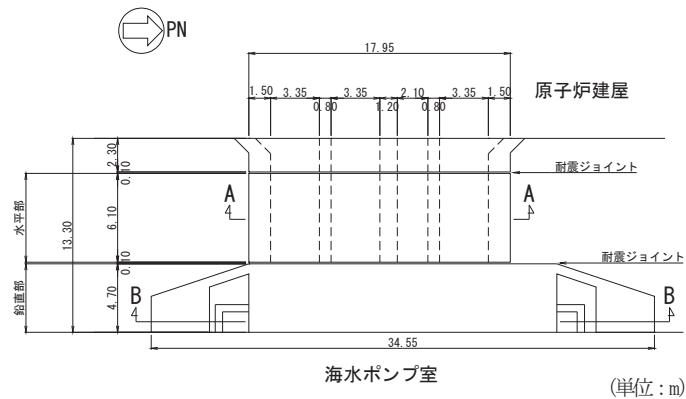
原子炉機器冷却海水配管ダクト平面図
